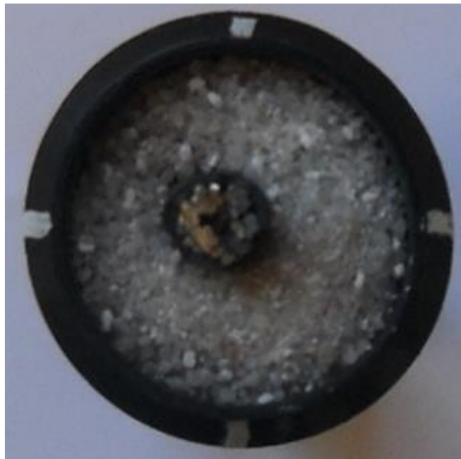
Mit Schrumpfschlauch ummanteltes Stahldrahtseile (\varnothing 5 mm) im Sondenrohr (\varnothing 25 mm) mit Sand ausgefüllt (Querschnitt bzw. Draufsicht).
